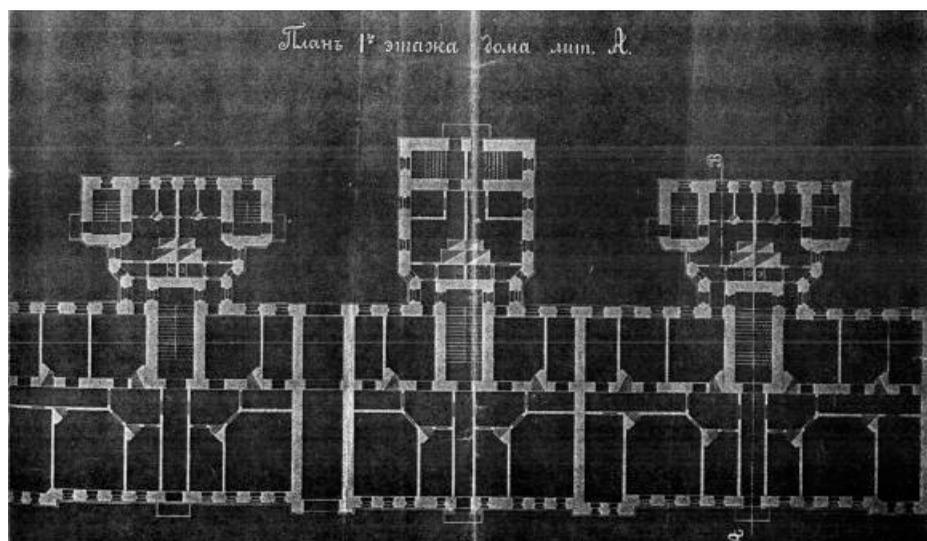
План первого этажа дома по ул. Фрунзе, 56. (Архивные чертежи)
